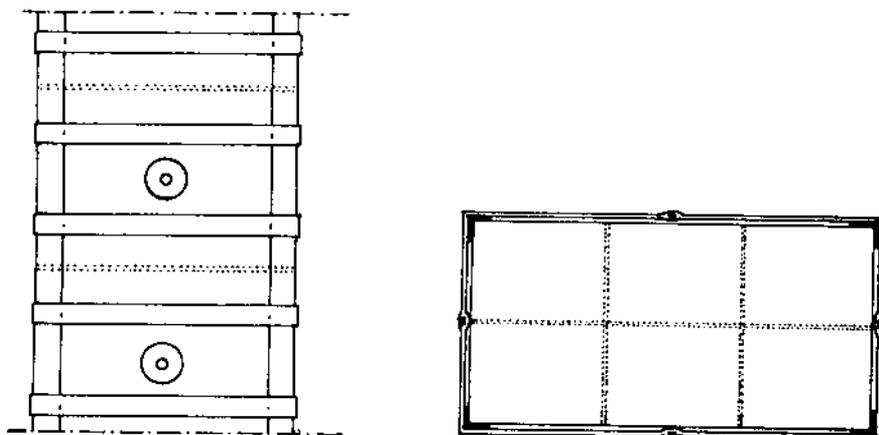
Schema di cerchiatura di un pilastro rettangolare.
